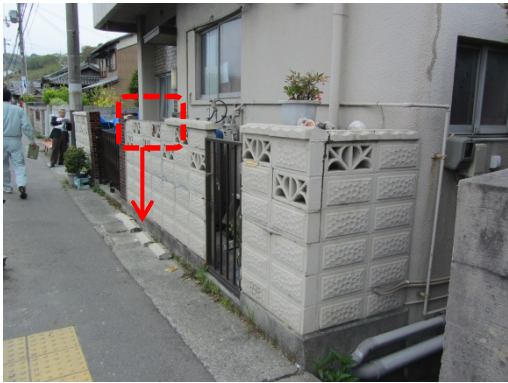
ブロック塀の破損・ひび割れ
